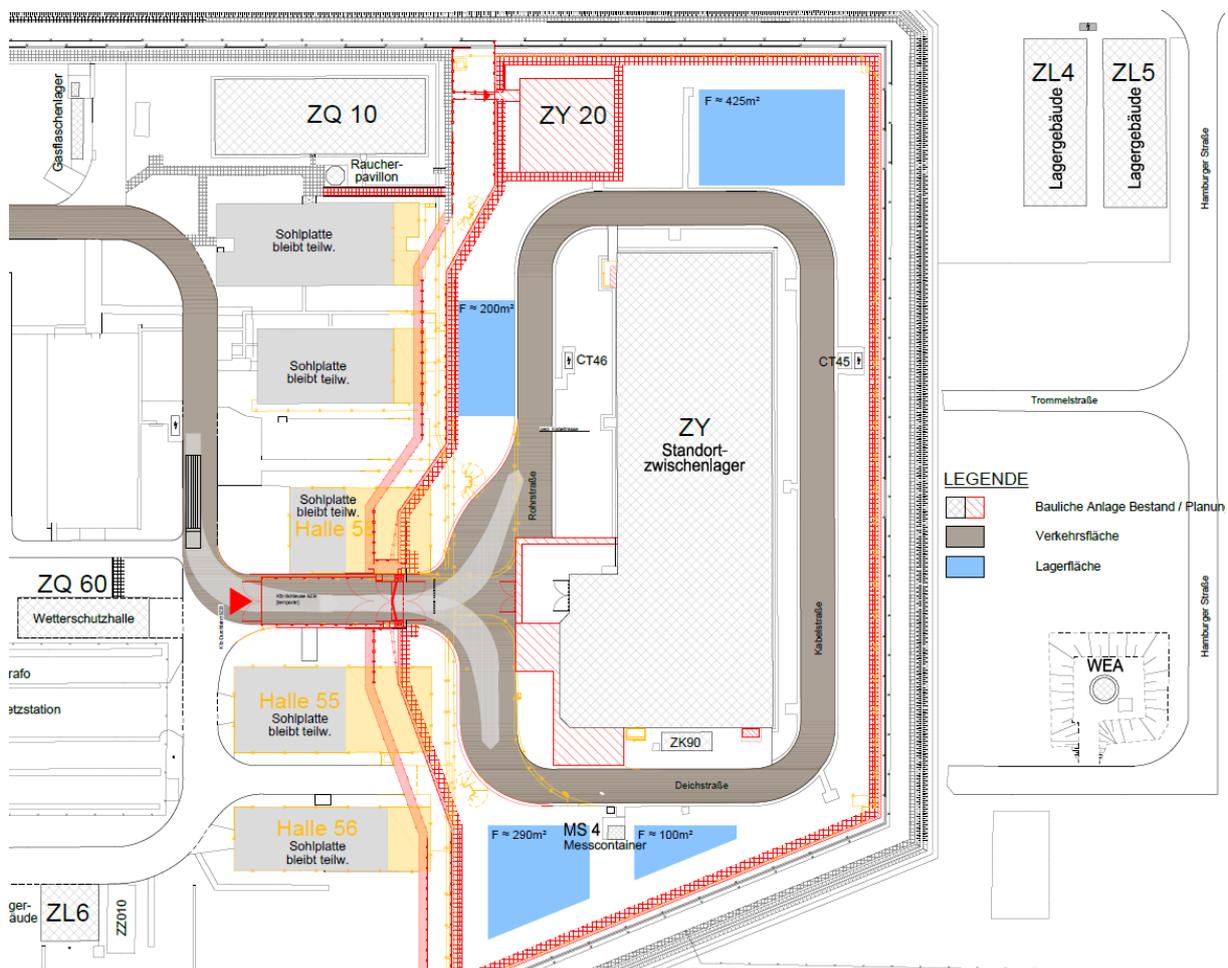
Lage der Baustelleneinrichtungsf lächen
